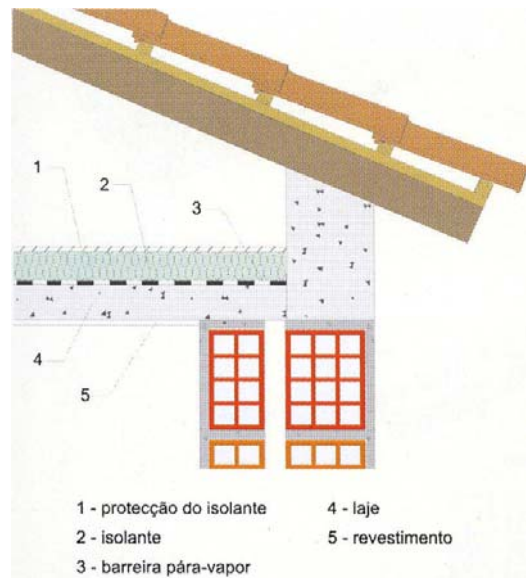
Colocação de isolante até ao limite da laje horizontal
